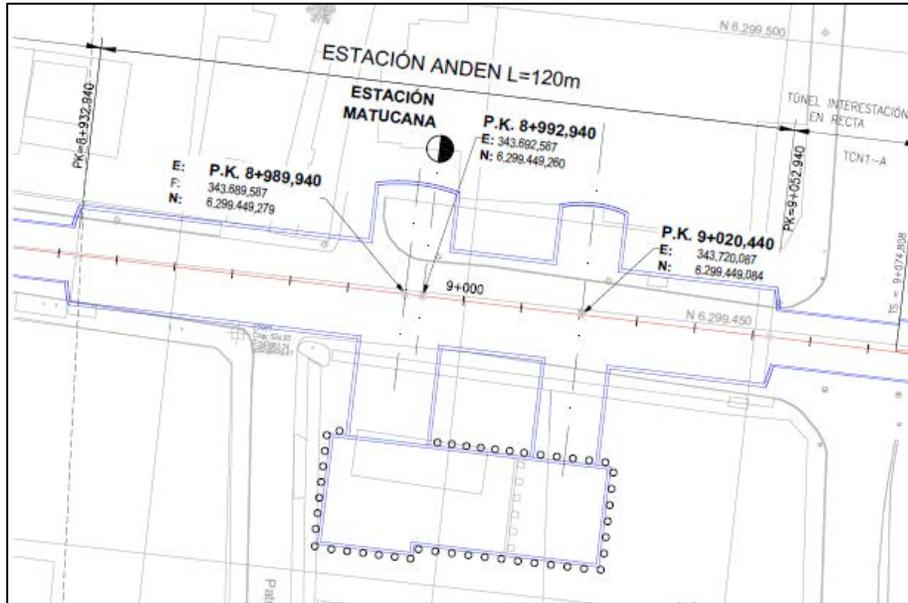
Planta Emplazamiento Pique Estación Matucana
